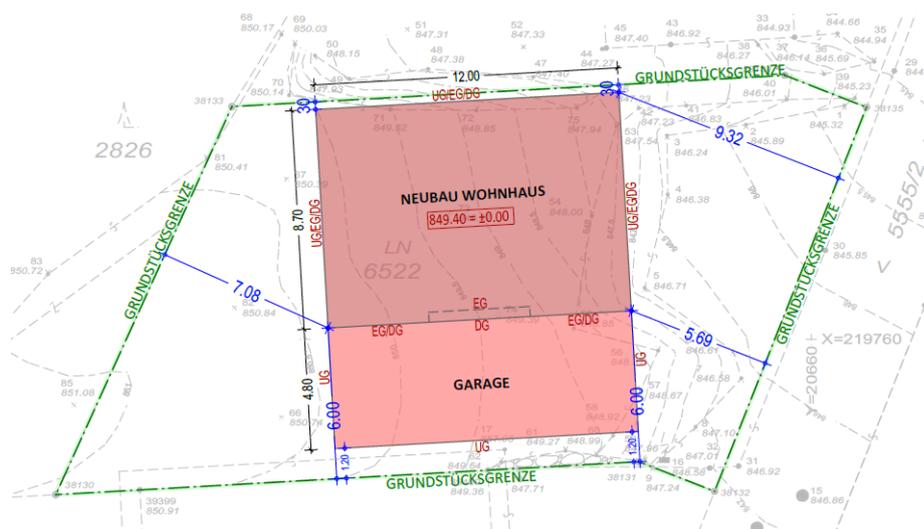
Lageplan des geplanten Bauvorhabens auf der Gp. 6522 seitens des Planers Herrn Thöni und dem Plandatum 21.02.2022 (ohne Maßstab).
